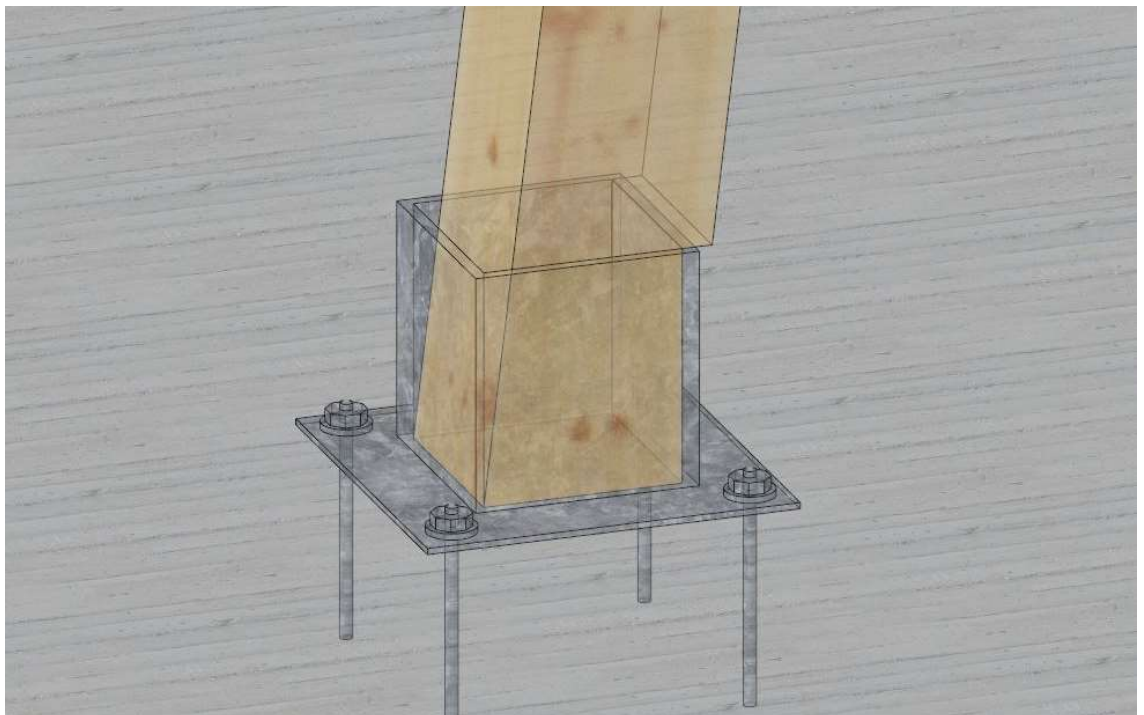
Imagen de cajetín metálico para pilar de 160x160mm de sección.
